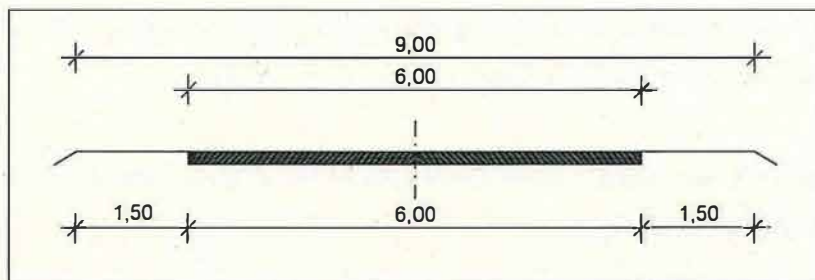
Straßenquerschnitt Betriebsumfahrung
